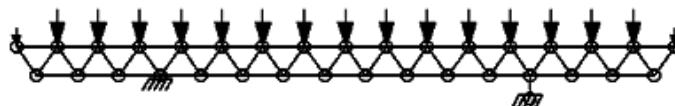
Расчетная схема для определения сил в стержнях условно плоской фермы.
